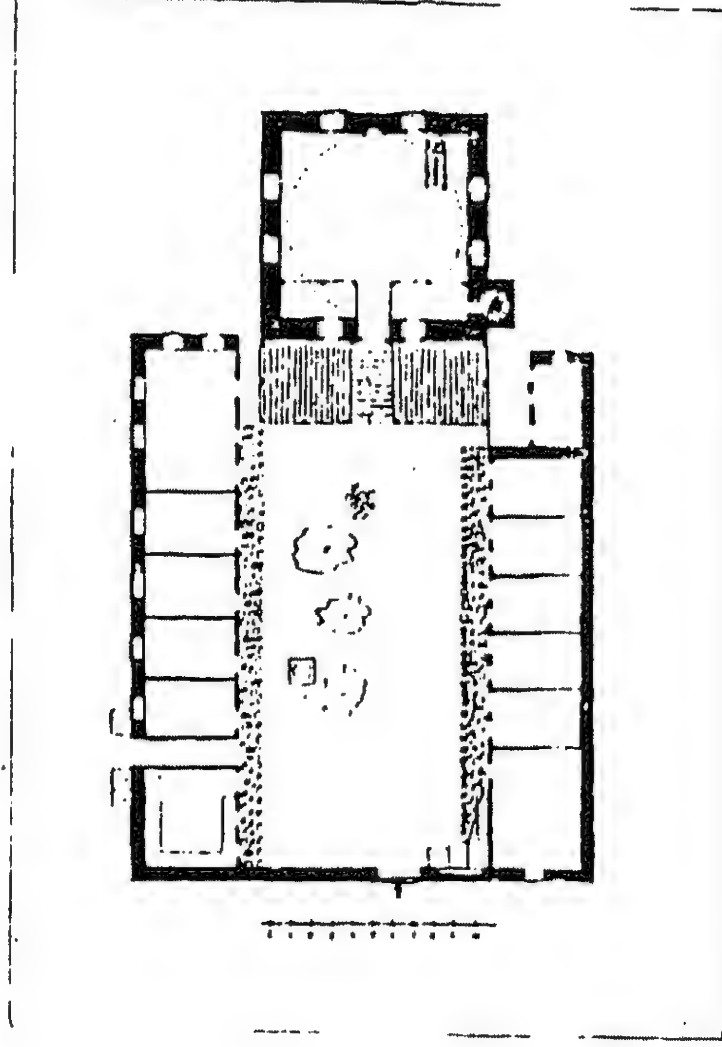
مسقط أفقي لمسجد الفاتح بعد تجديده (عن : جابرييل) .
